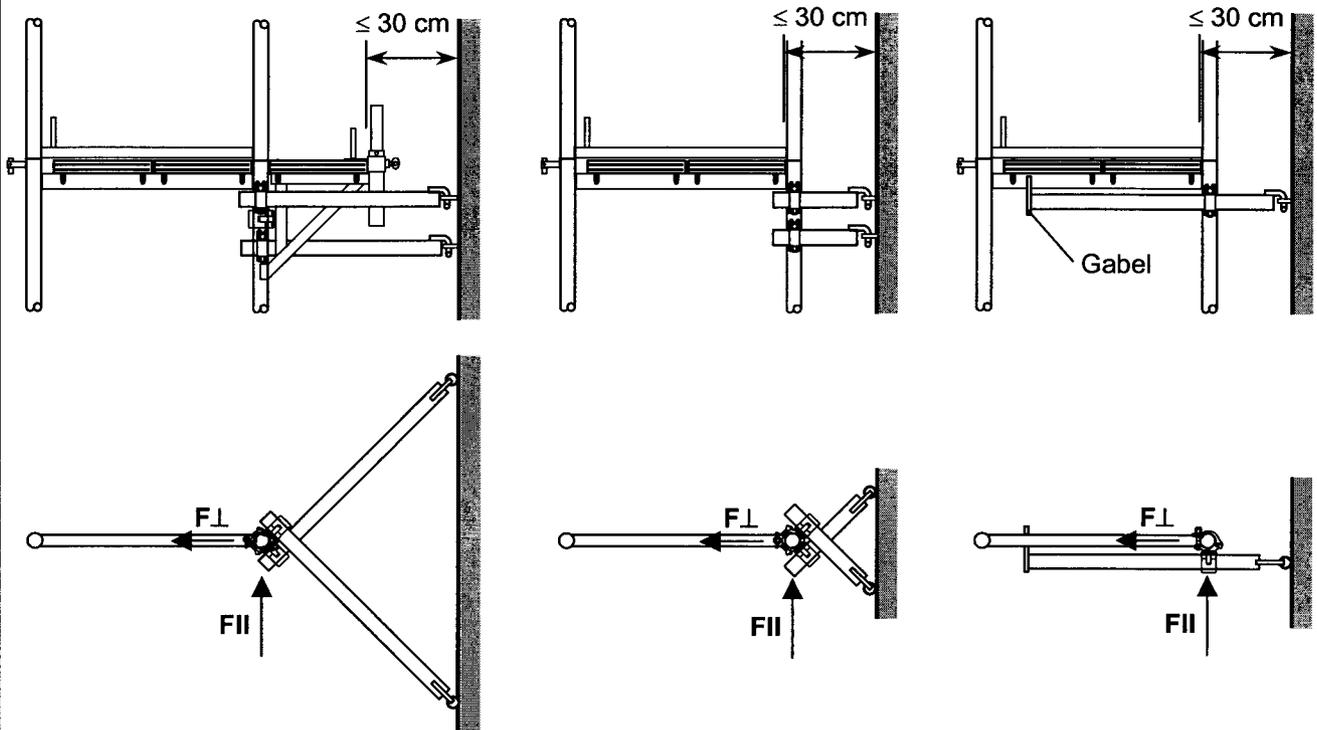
Höhenlage der Gerüsthalter bei Anschluss im „Knoten“.
